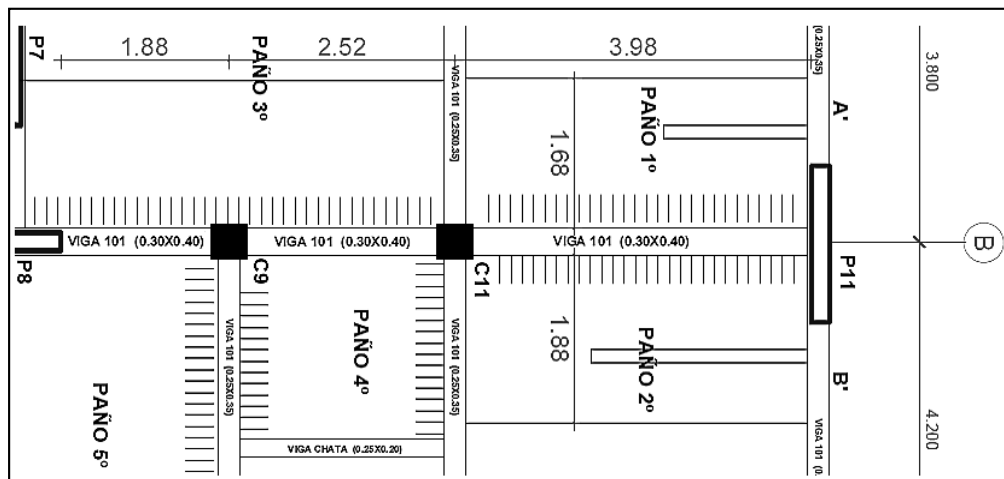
Viga Longitudinal 101(0.30X0.40) Eje B-B Tramo 3-5
